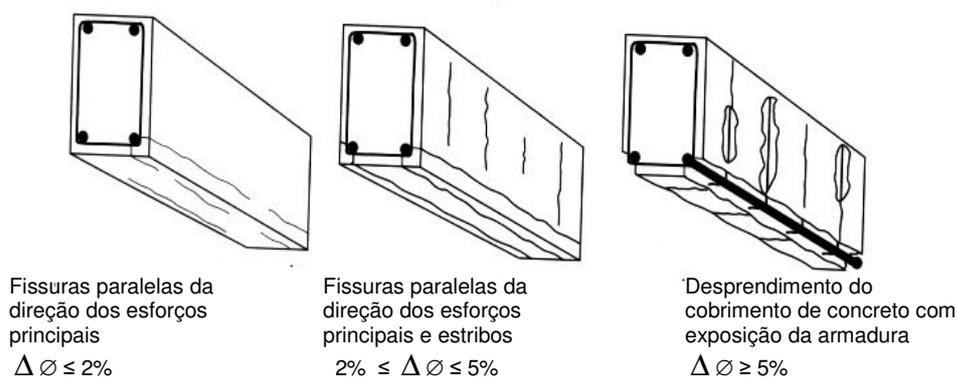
Representação esquemática das patologias tipicamente observadas em vigas de concreto afetadas por corrosão (HELENE, 2003).
